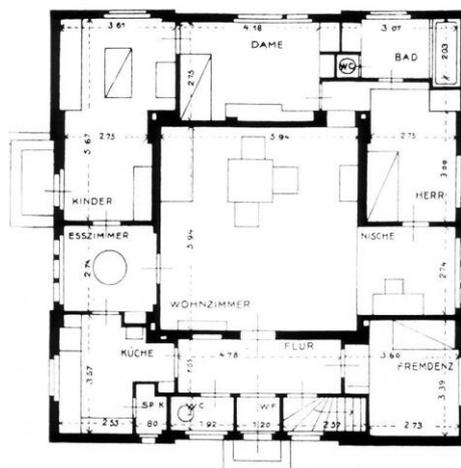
Planta da casa experimental Am Horn, Bauhaus
